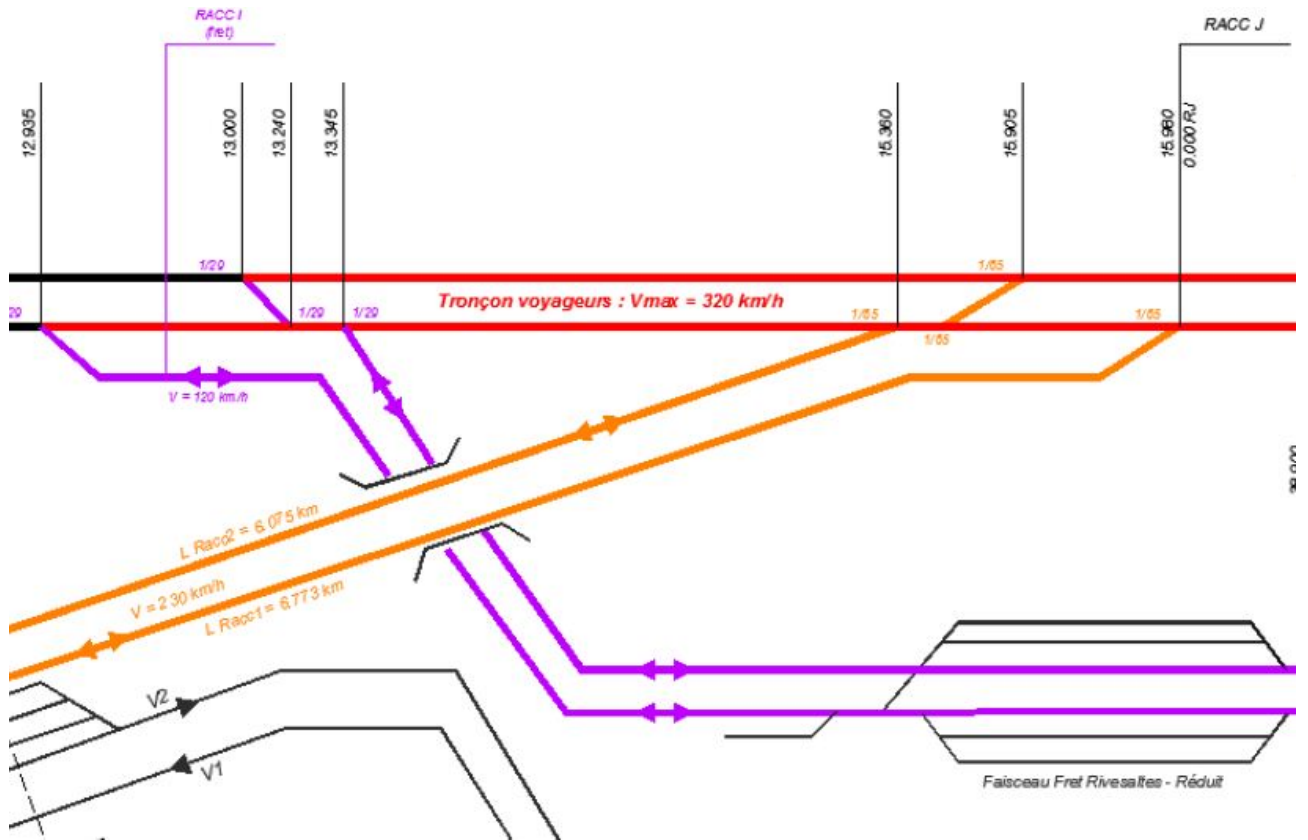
Secteur Camp Joffre - Schéma installation ferroviaire sans gare
